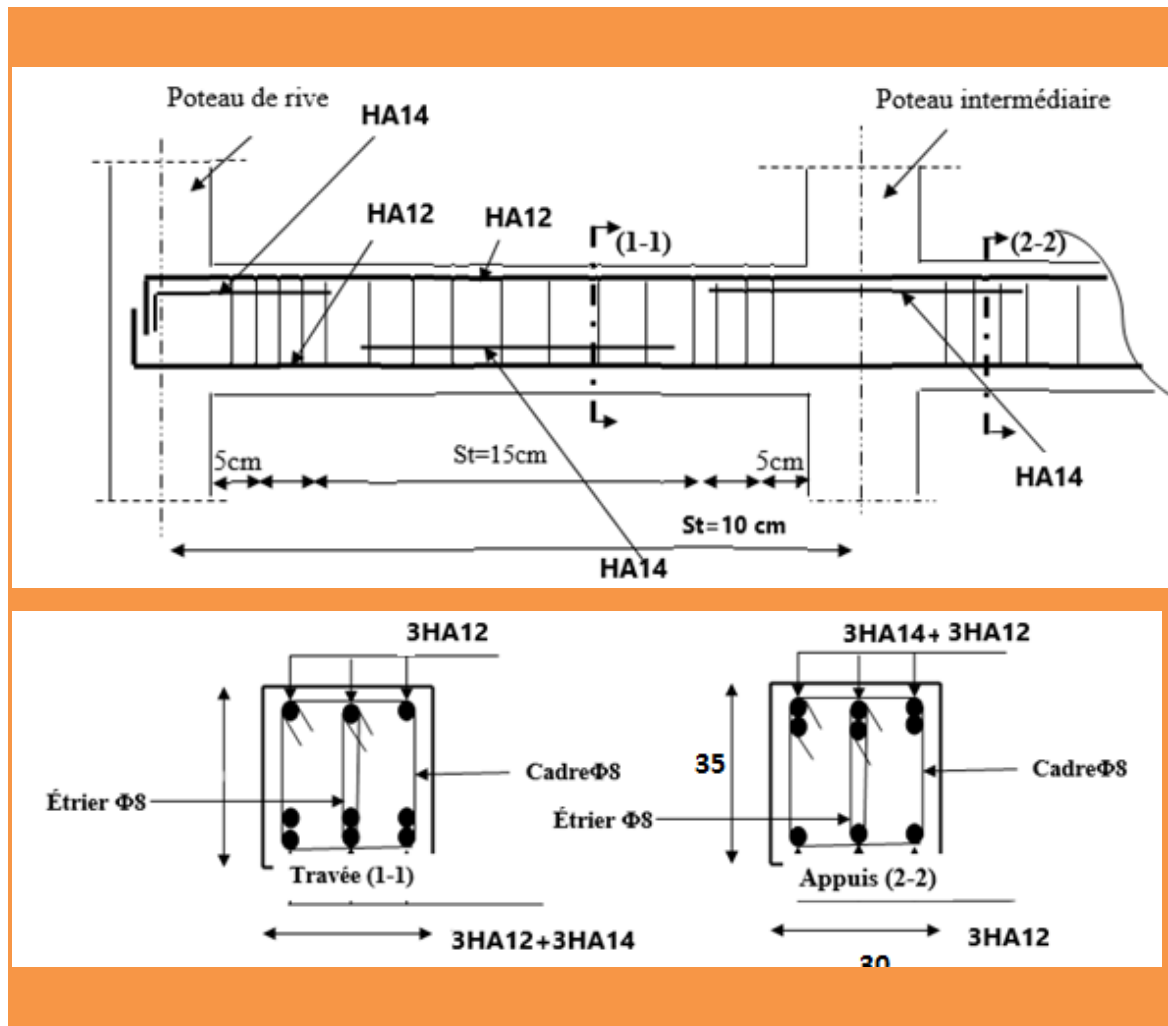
schéma de ferrailage de la poutre principale(30*50)
